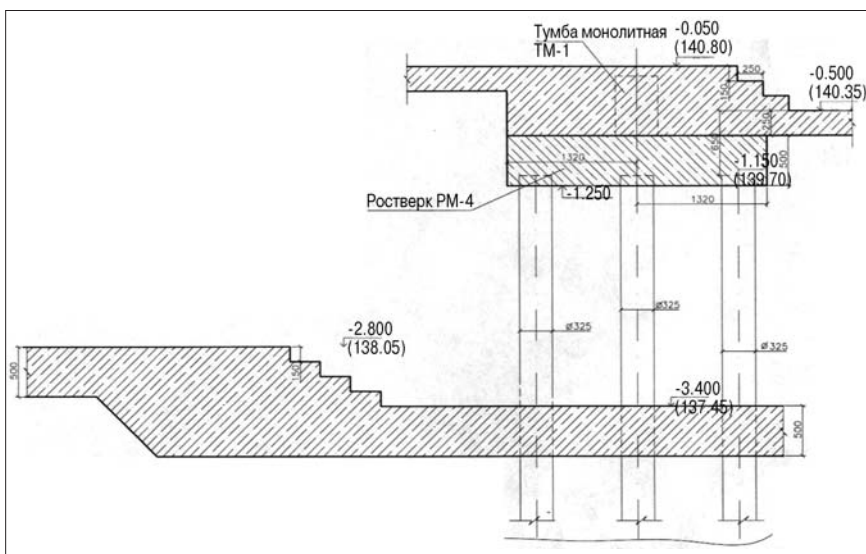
Разрез по плите-ростверку после возведения фундаментной плиты
